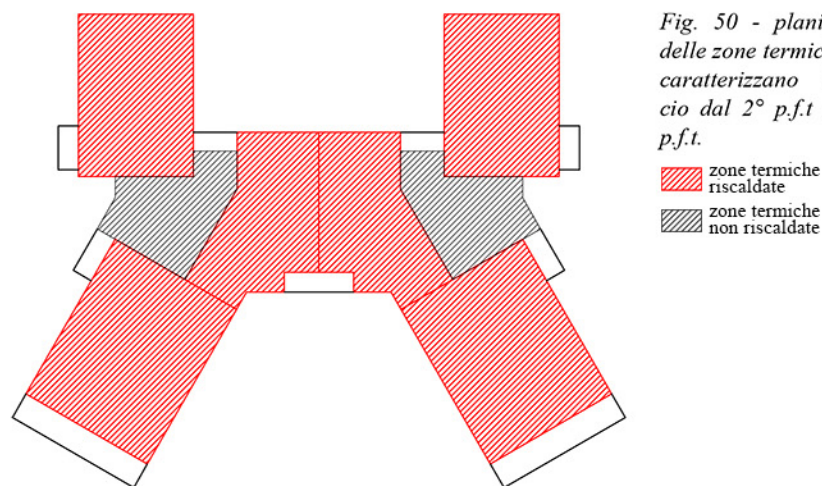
planimetria delle zone termiche che caratterizzano l'edificio dal 2° p.f.t al 16° p.f.t.
